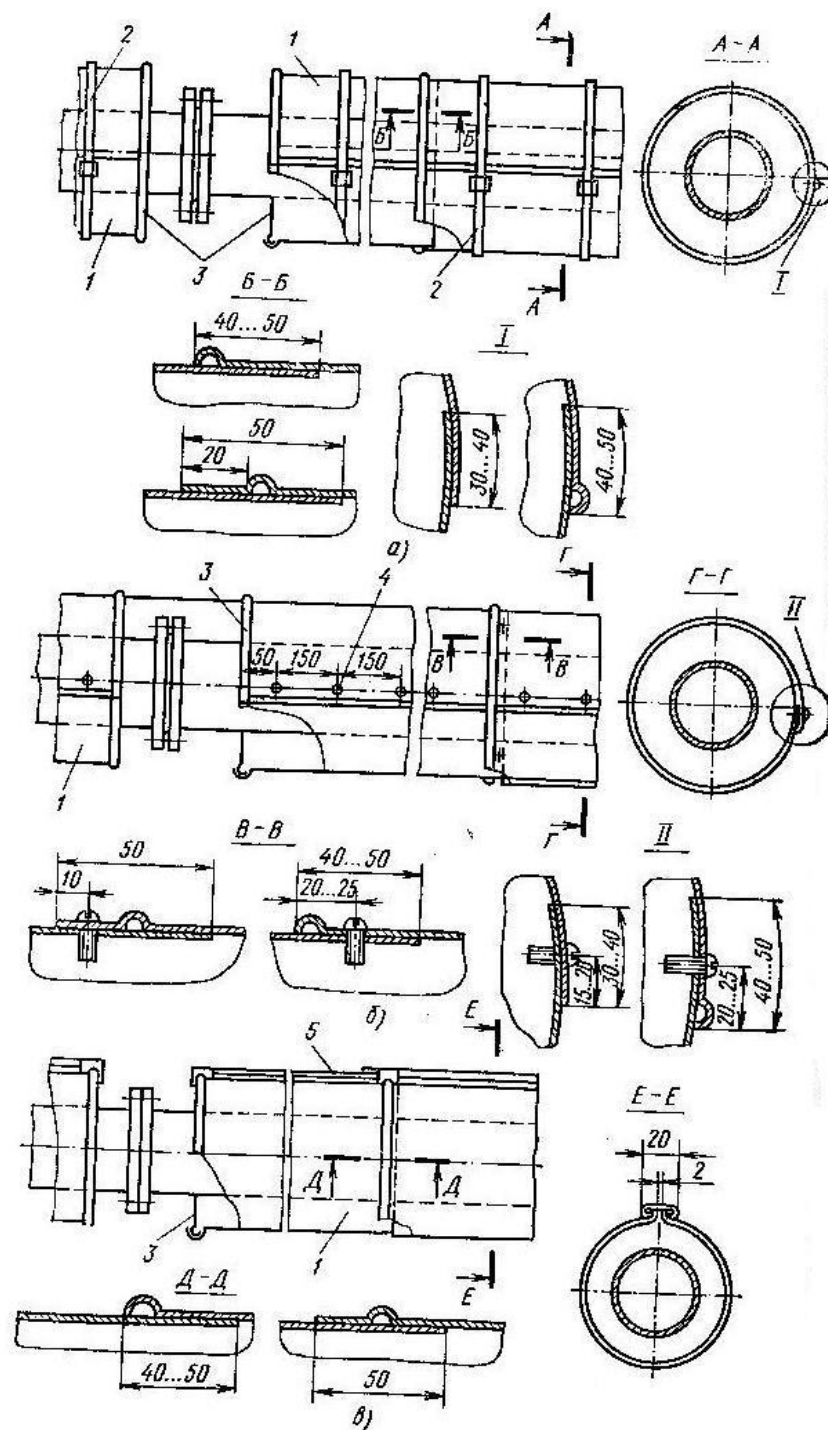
Изоляция оборудования жесткими изделиями на стяжках: 1 — проволоочный каркас, 2 — теплоизоляционные плиты, 3 — бандаж, 4 — проволоочное кольцо
